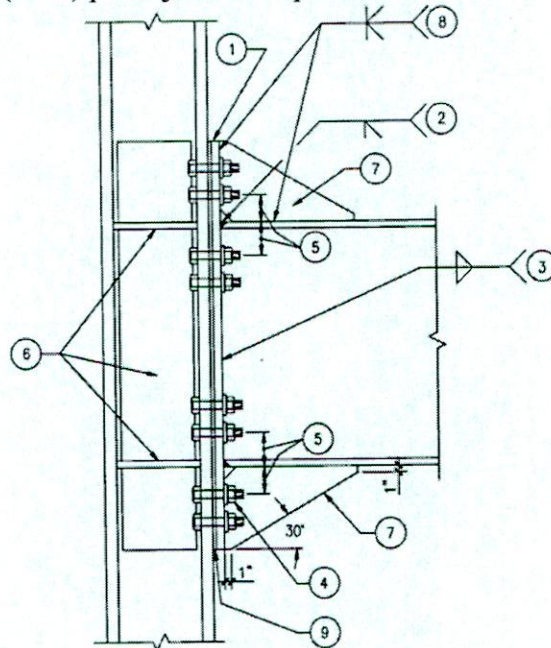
Conexión Apernada con Plancha extrema con atiesador
